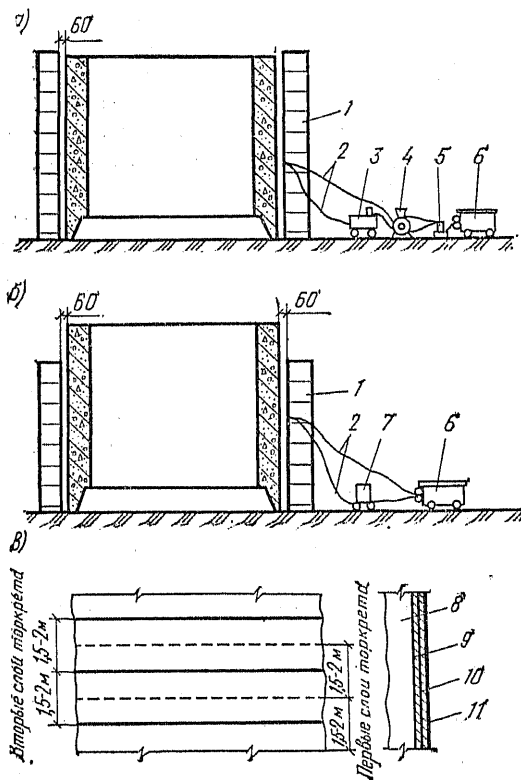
Гидронизоляция стен опускного колодца торкретированием
